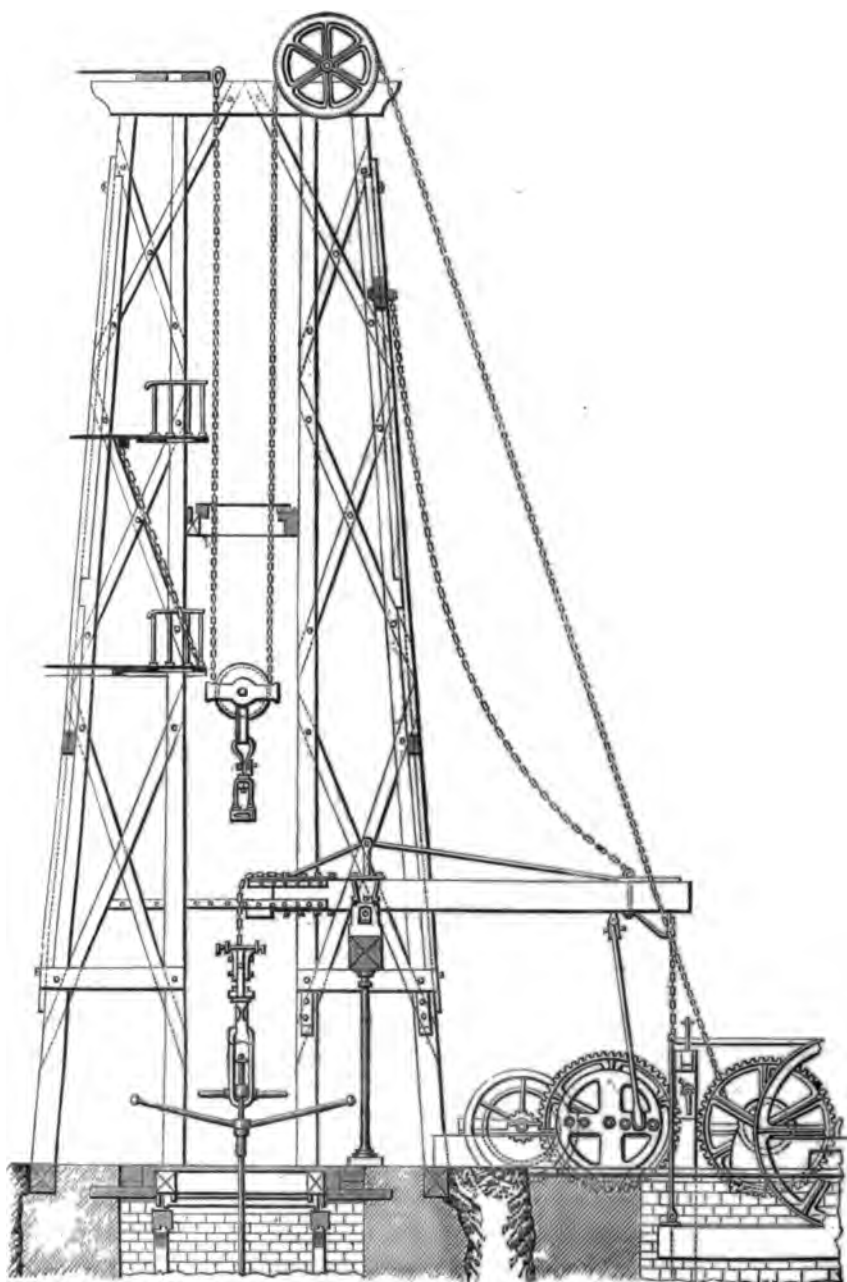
Installation du puits de La Chapelle, par MM. Defoussé et Laurent.
